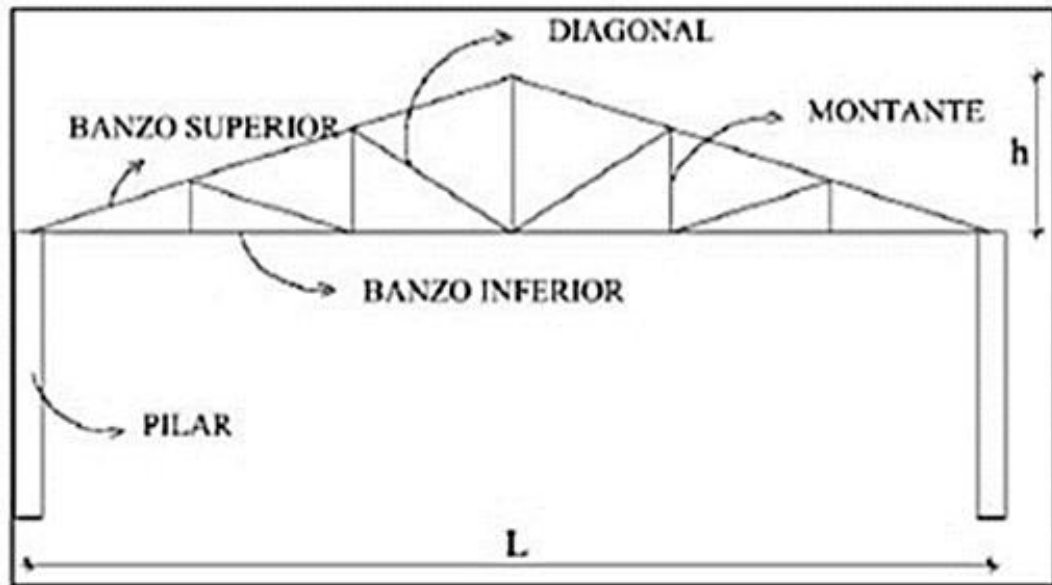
Modelo construtivo de um galpão com viga treliçada
